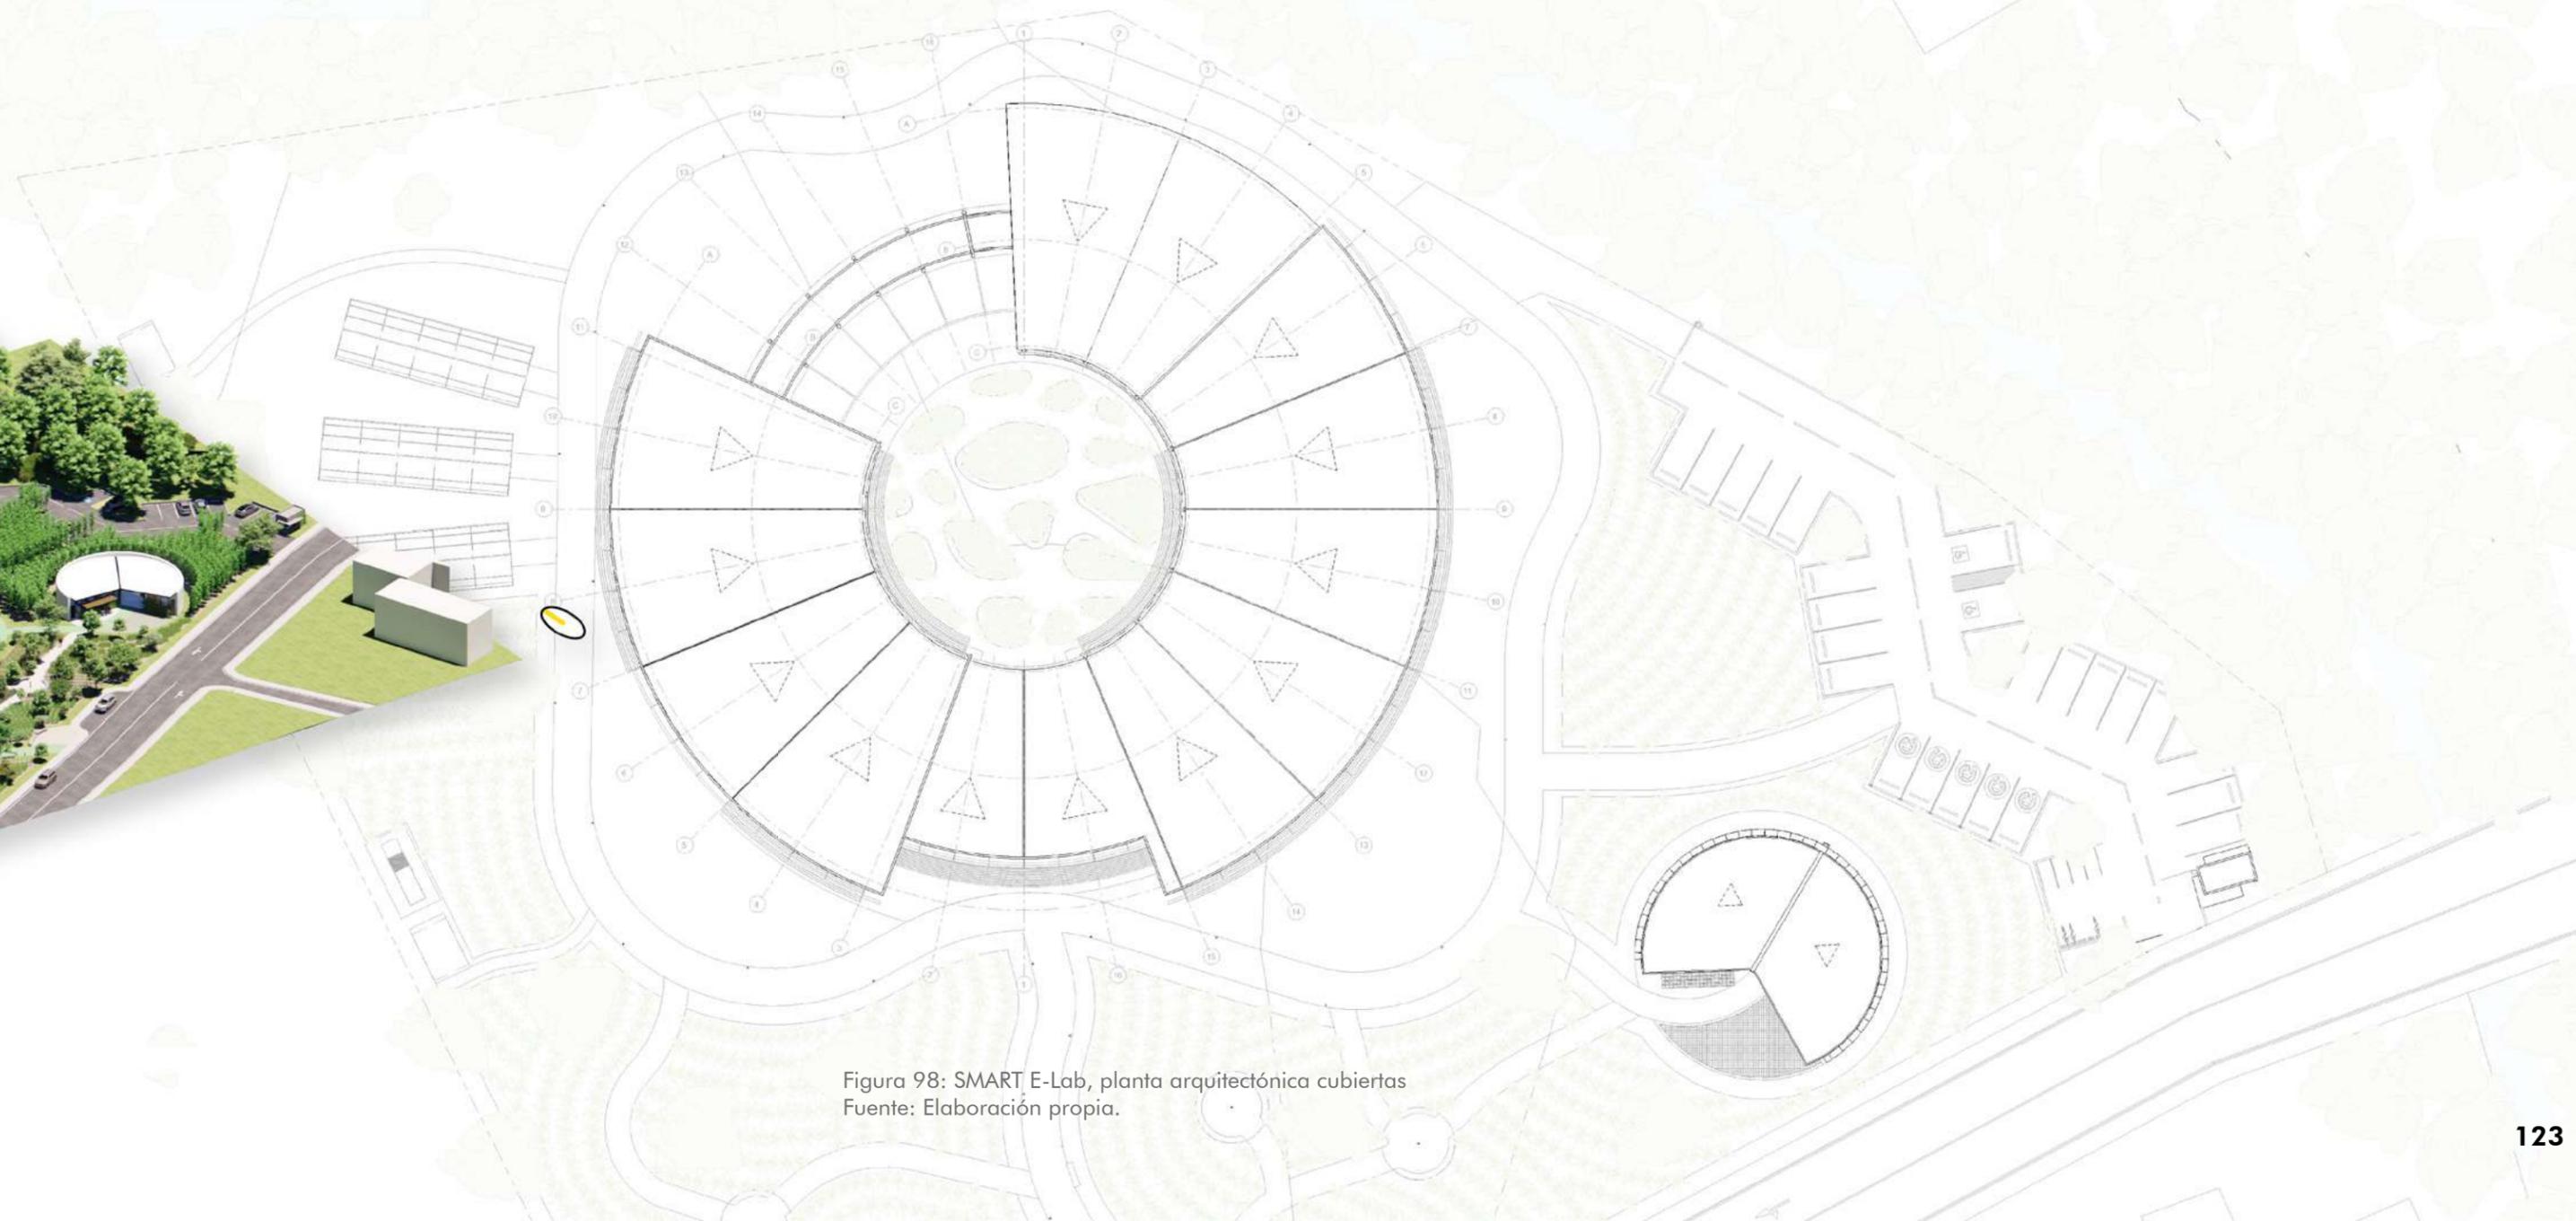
SMART E-Lab, planta arquitectónica cubiertas
